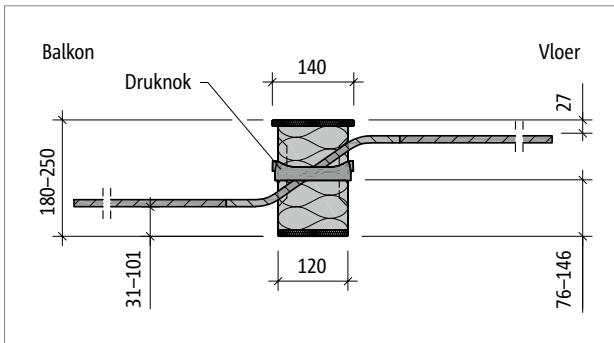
Schöck Isokorf® XT type Q-E: detail B
